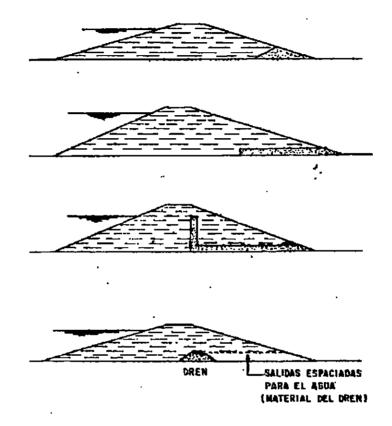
Algunos tipos comunes de drenes en presas de sección homogénea
